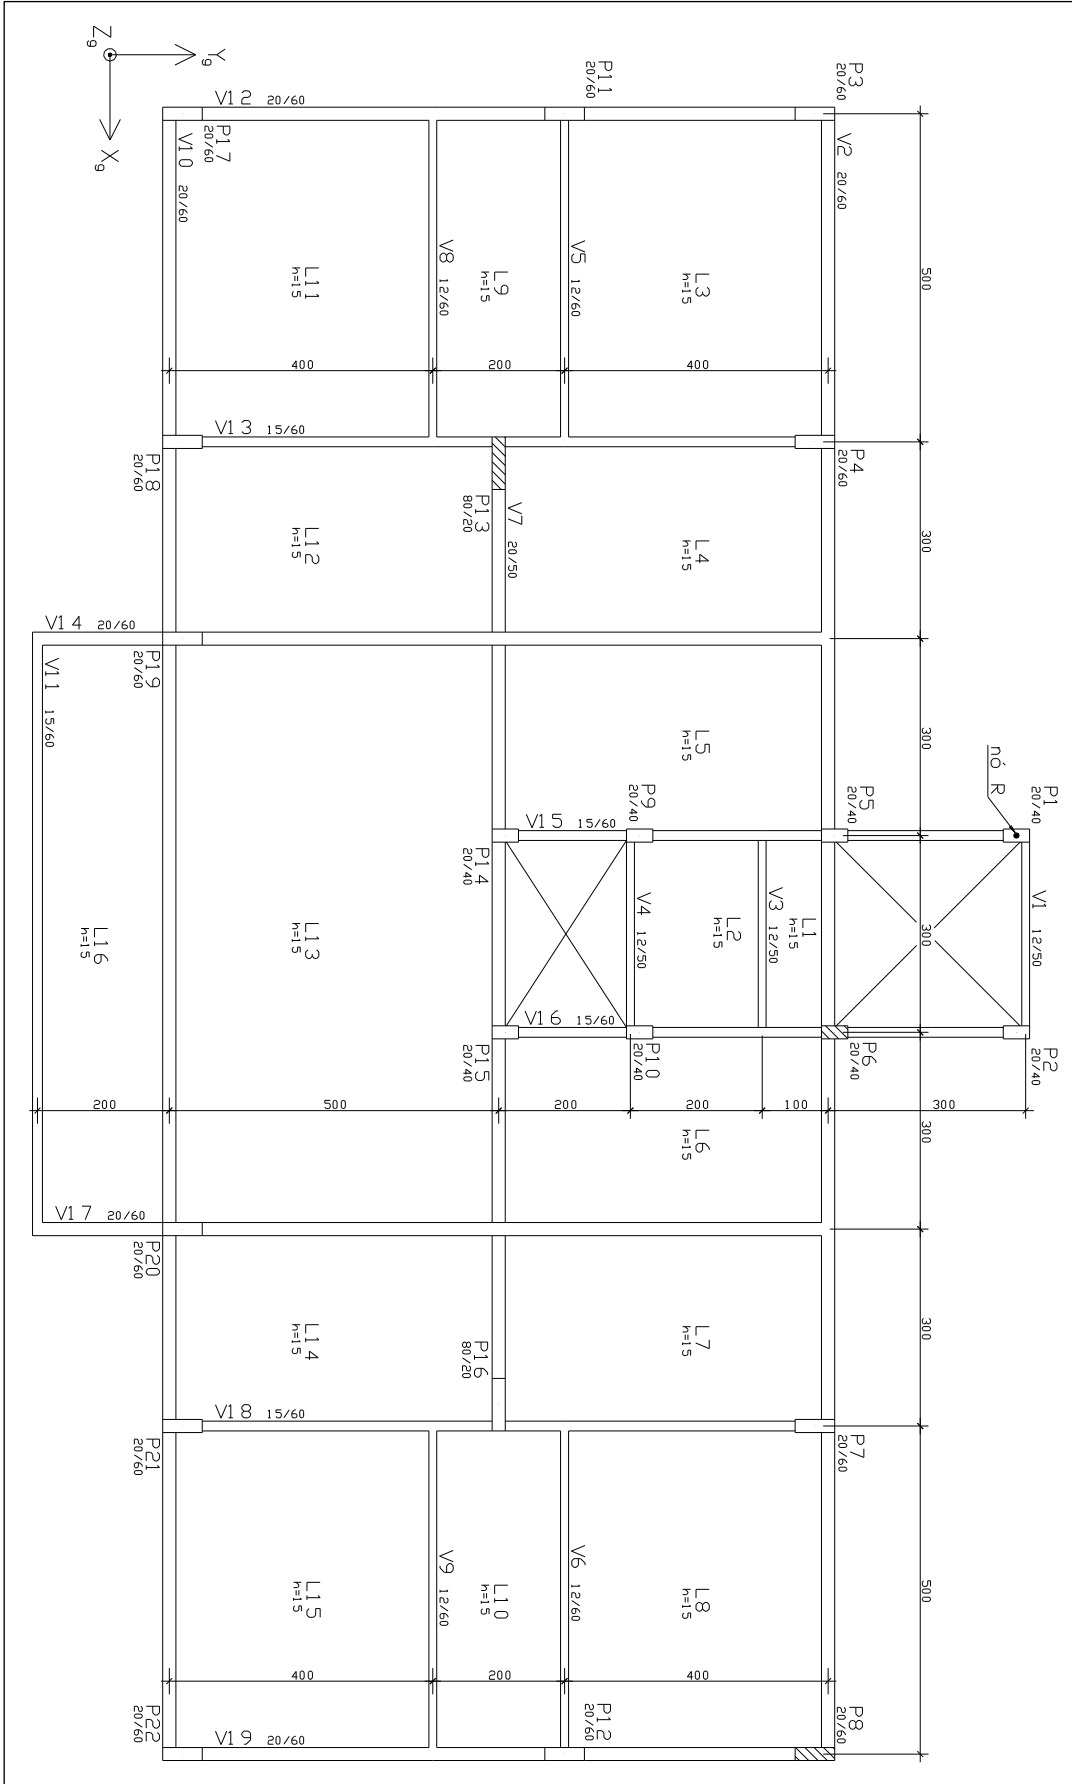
planta baixa do pavimento tipo – exemplo 2
